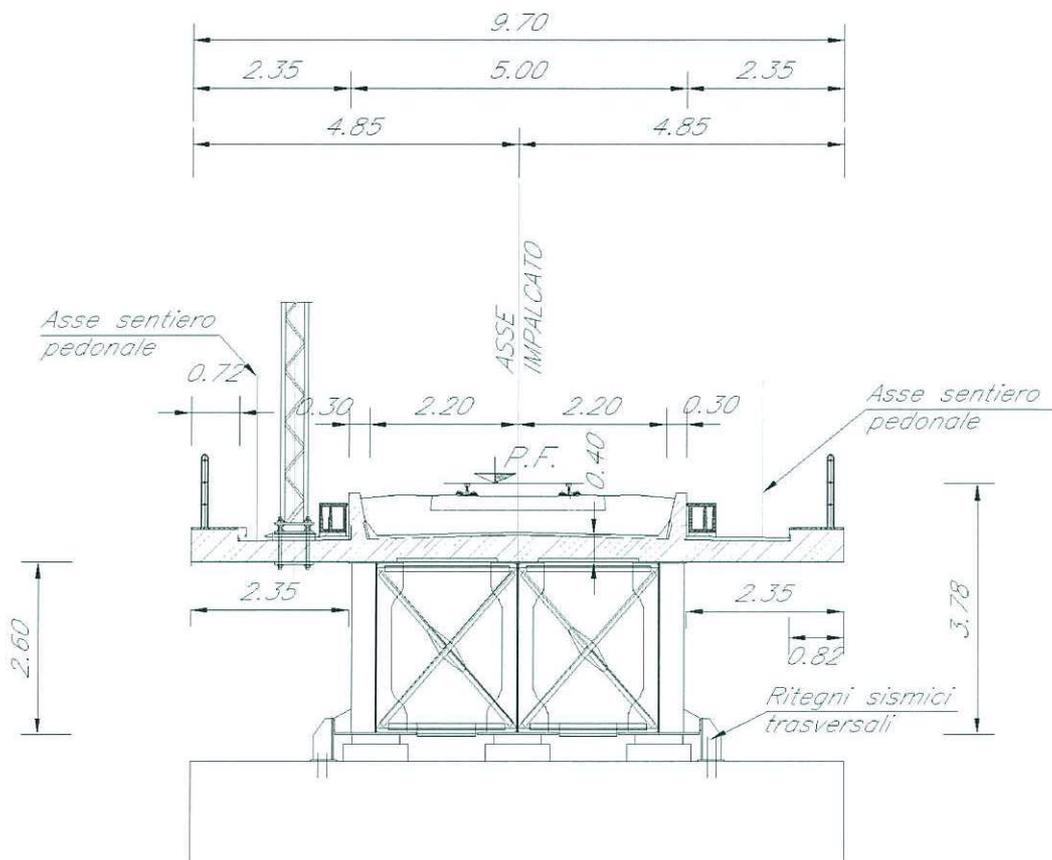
Sezione trasversale impalcato a struttura mista acciaio/cls.
